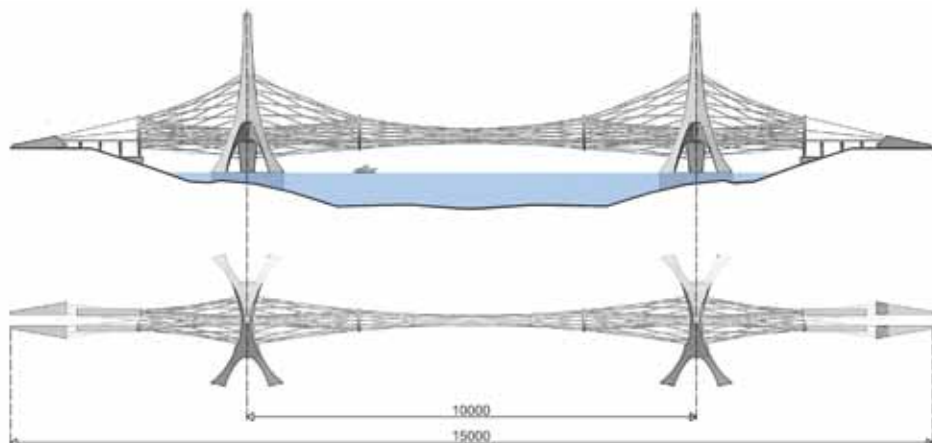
Prospetto e pianta della nuova proposta di attraversamento.
